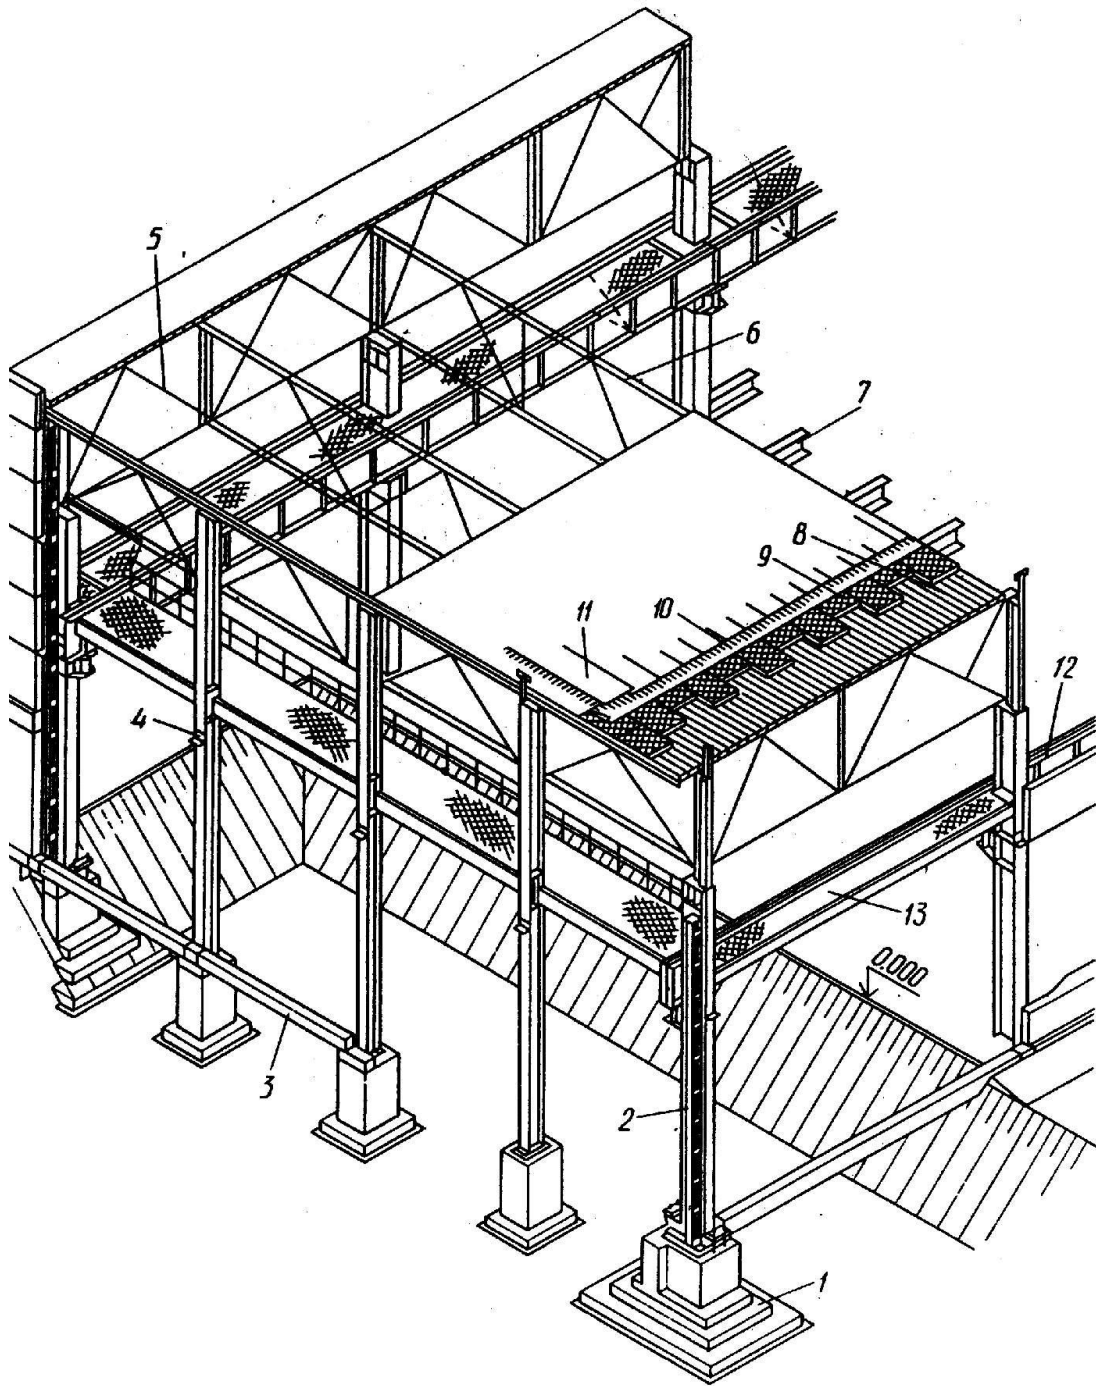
Стальной каркас со стропильными и подстропильными фермами
